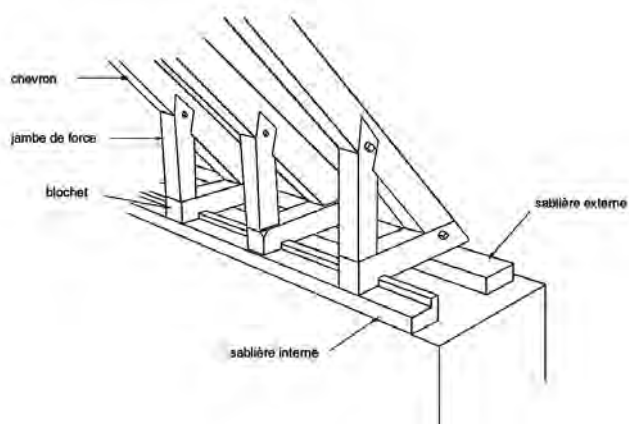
Assemblages des pieds de fermes aux sablières.
